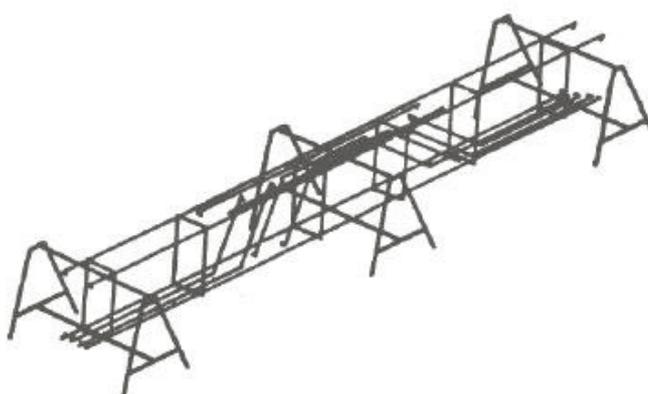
Montagem de armaduras sobre cavaletes – fase 2.
